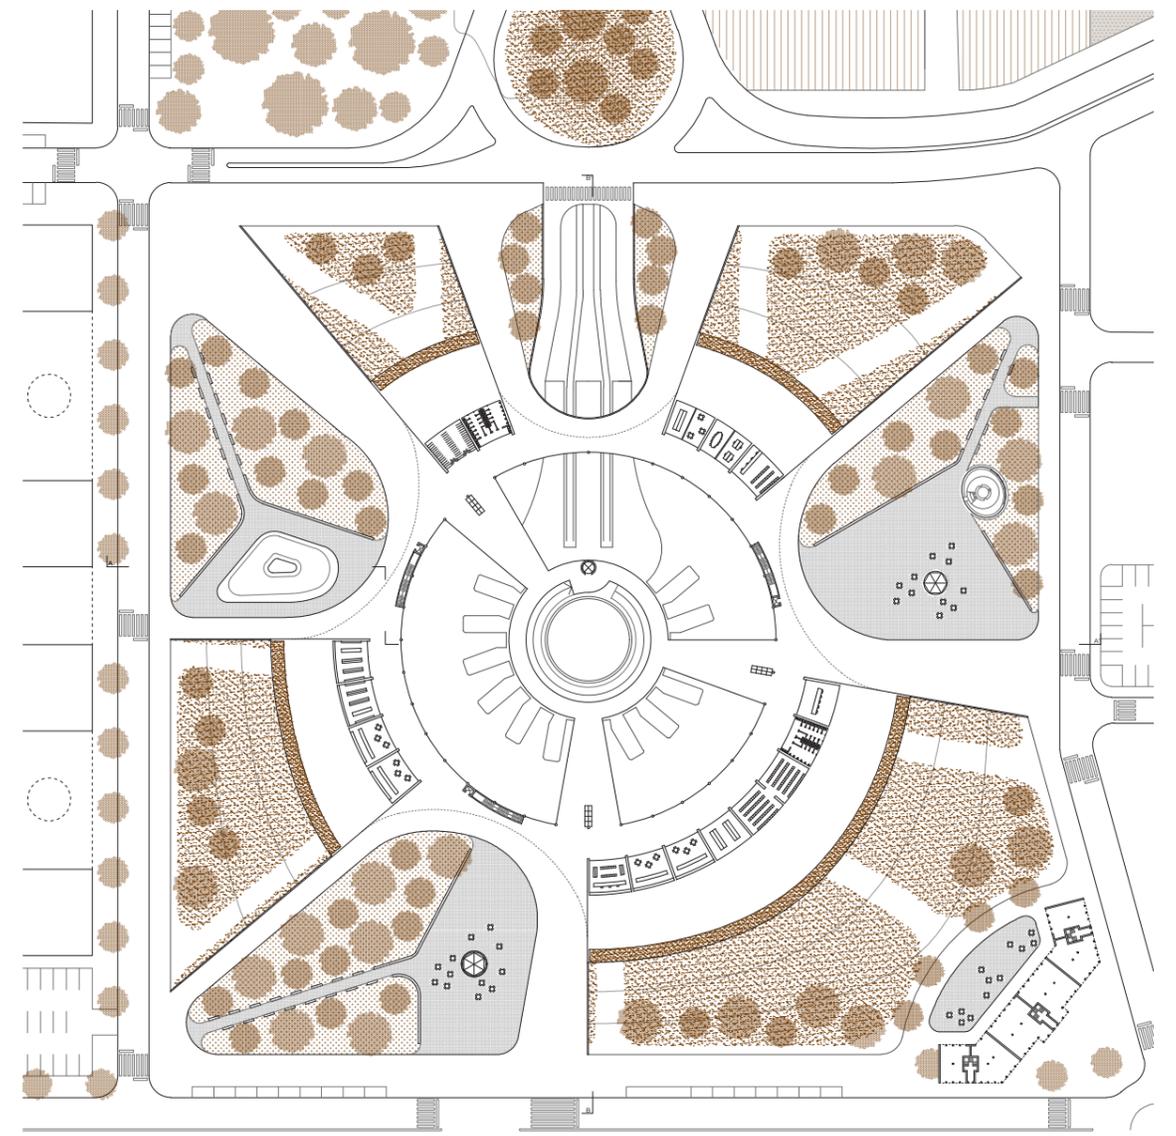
PLANTA DO PISO TÉRREO REDUÇÃO DA ESCALA 1:1000
